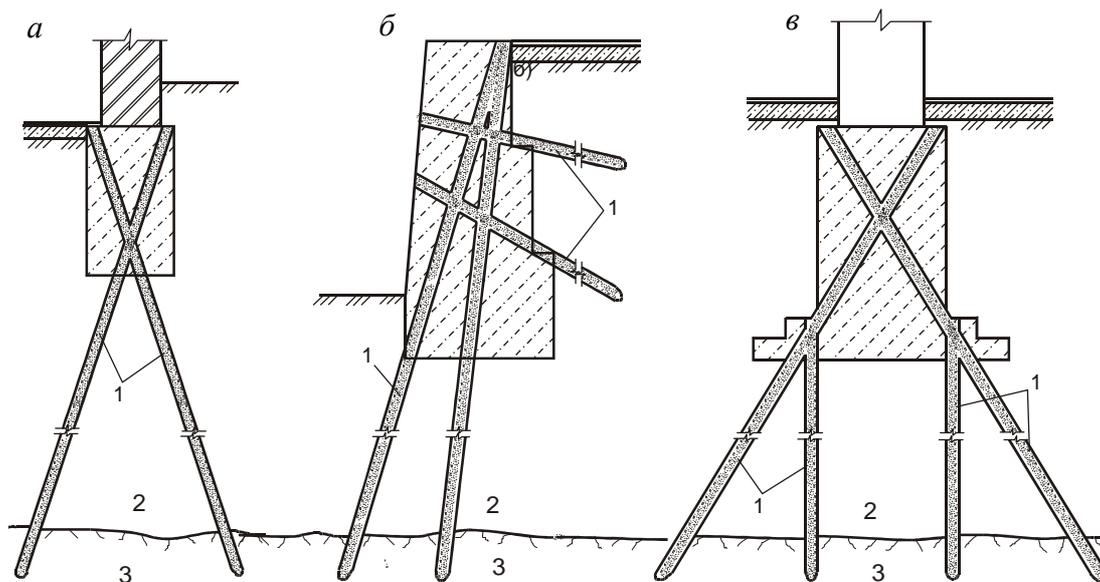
Усиление буроинъекционными сваями фундаментных конструкций:
